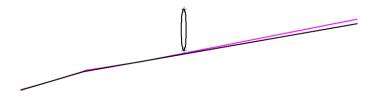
Drenaje Mostrado en el Perfil de SECTION-0
